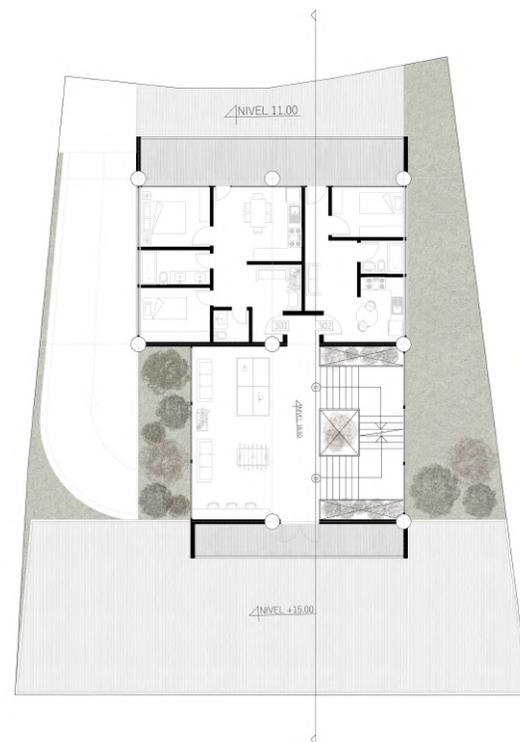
Segunda Planta Nivel 18.50 Vivienda multifamiliar. Elaboración Propia
